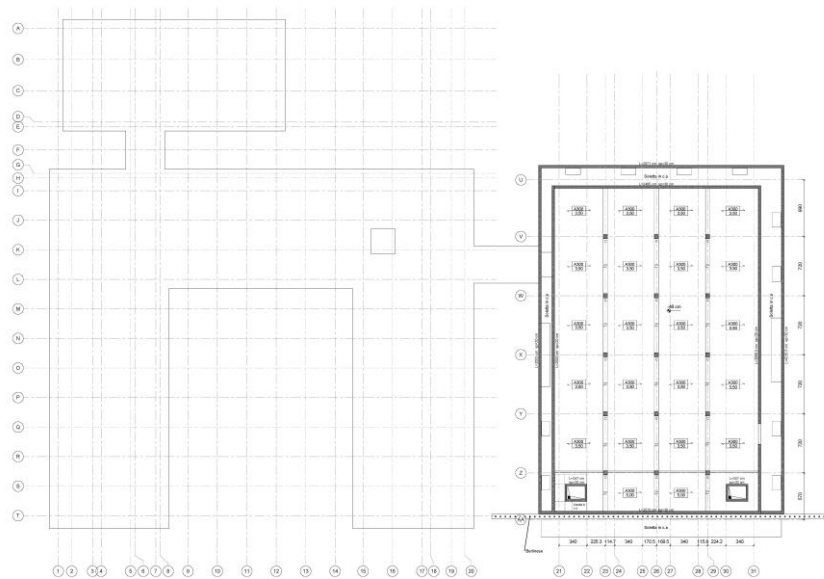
Edificio A: Vista speculare impalcato del piano terra
